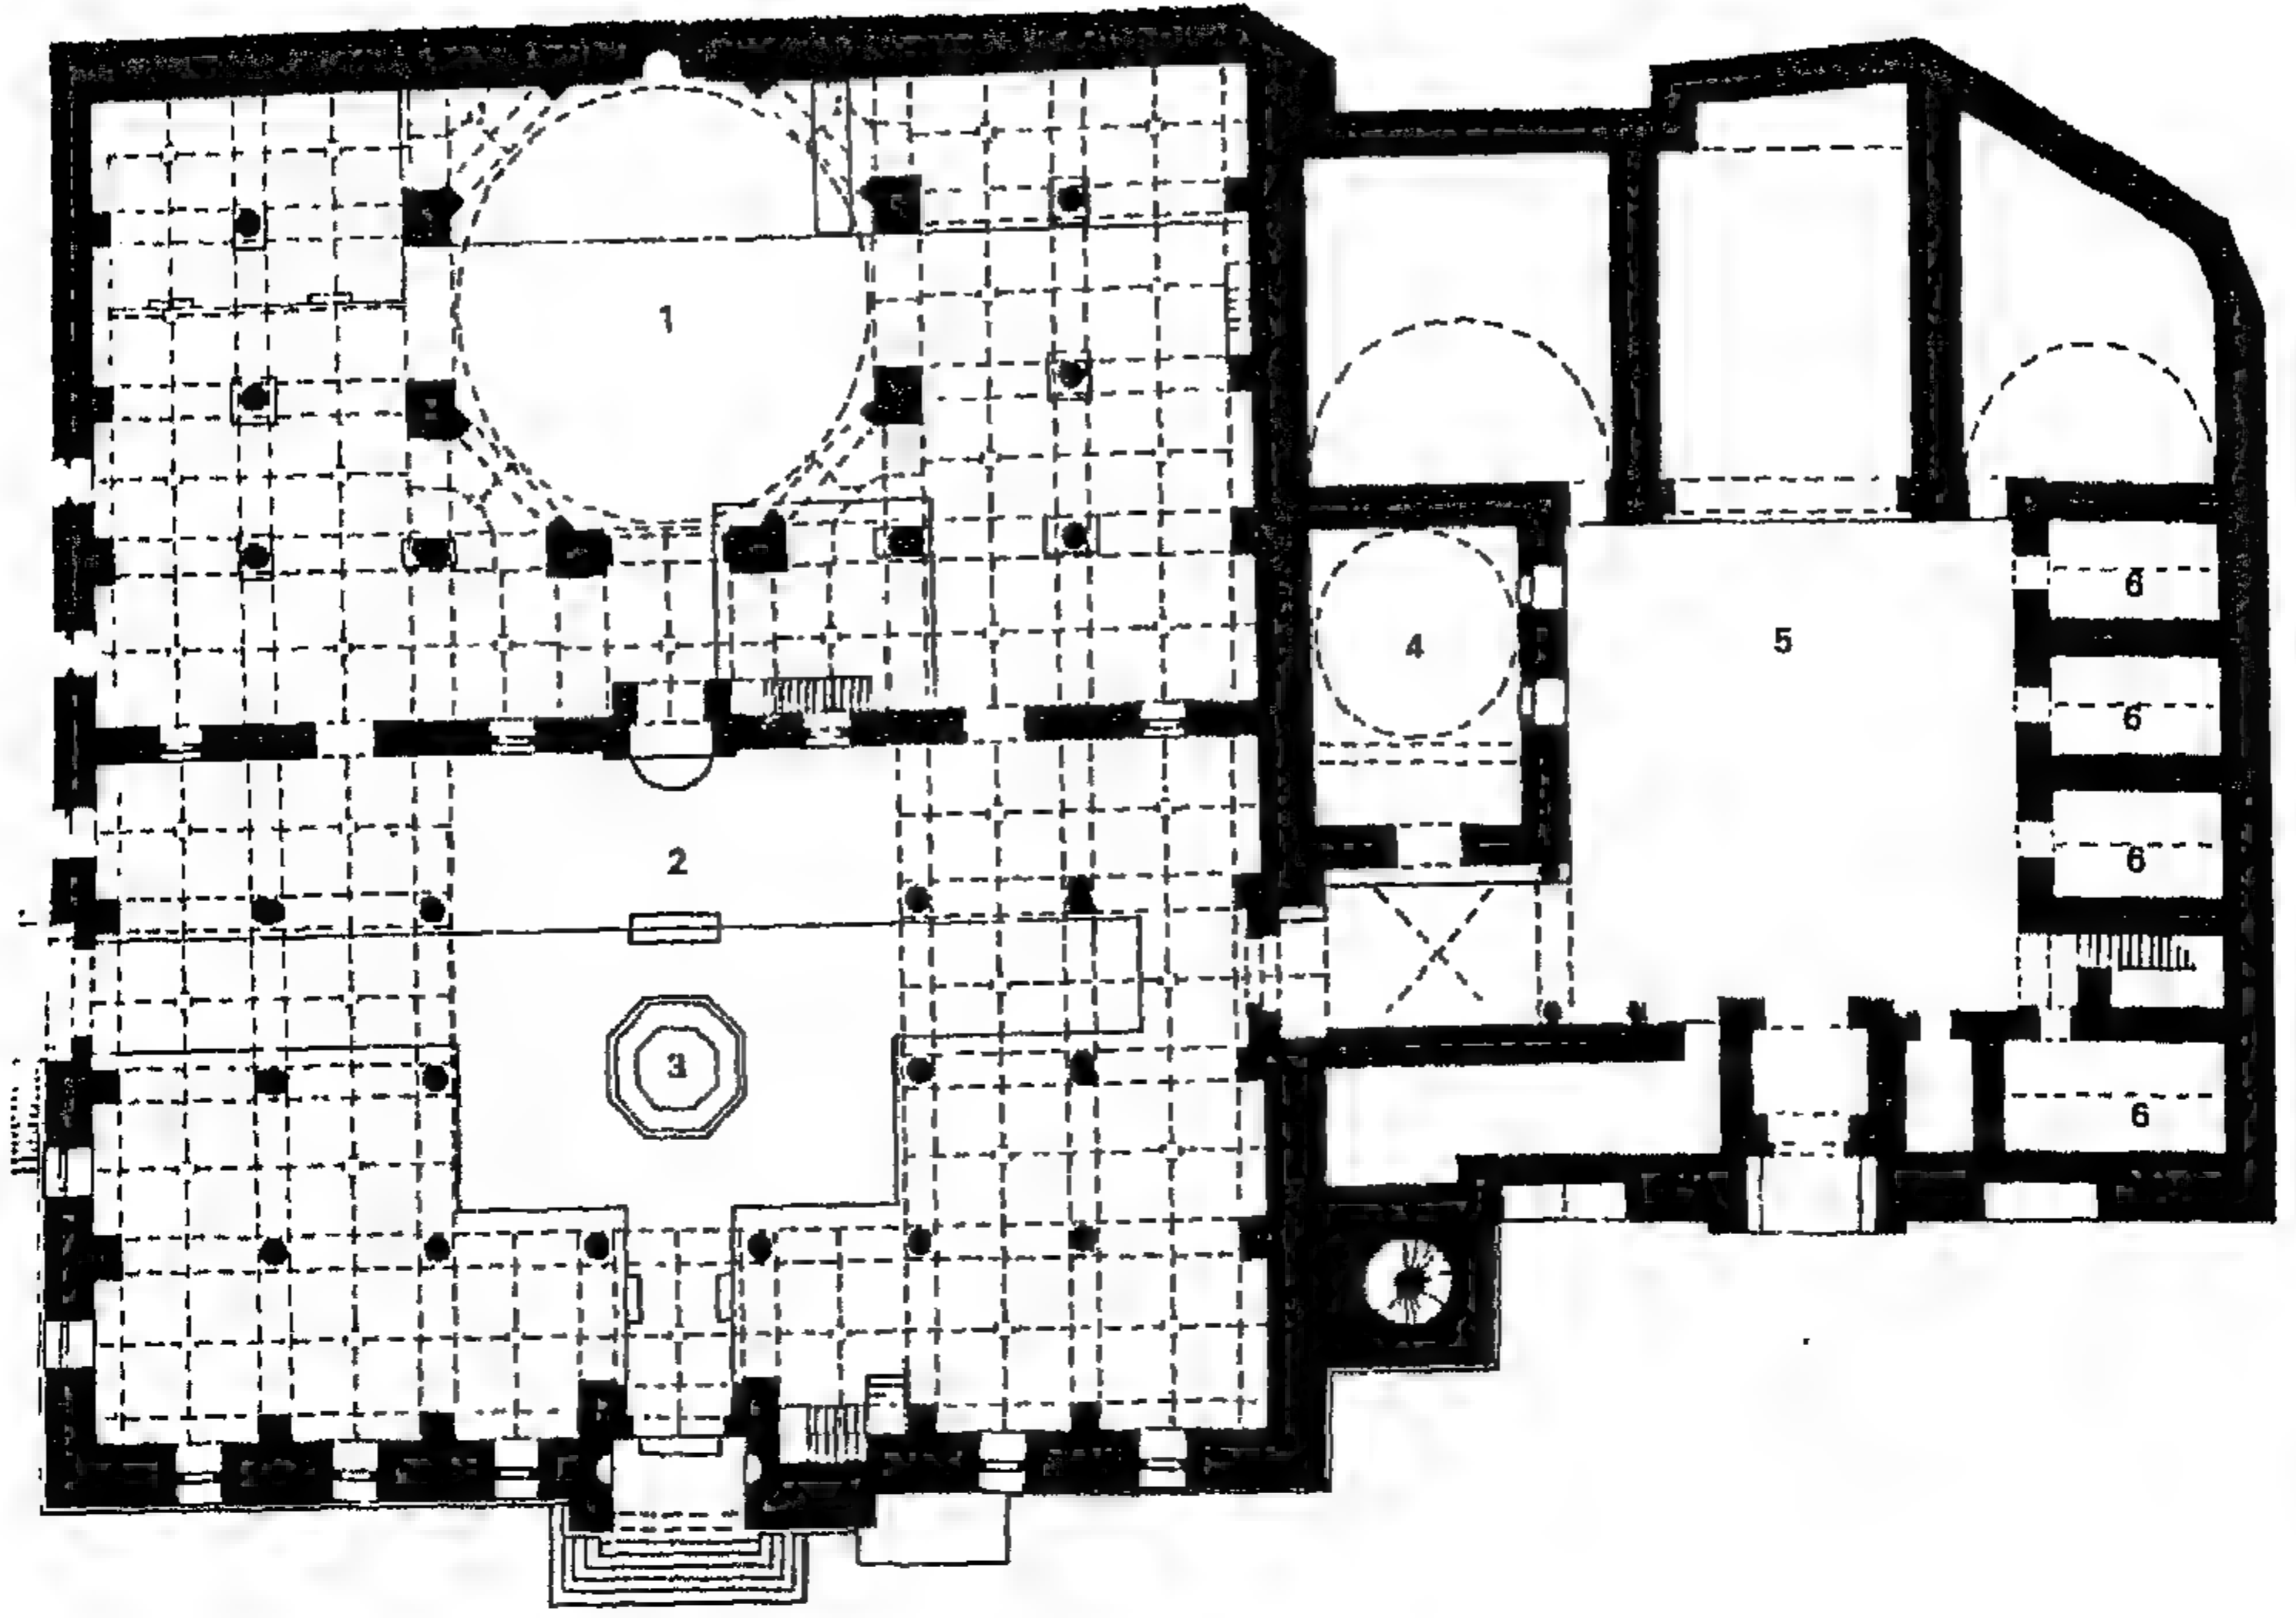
مسقط أفقي للجامع الكبير في دنيسر (قزيل تبه) (عن : أصلان آبا) .
